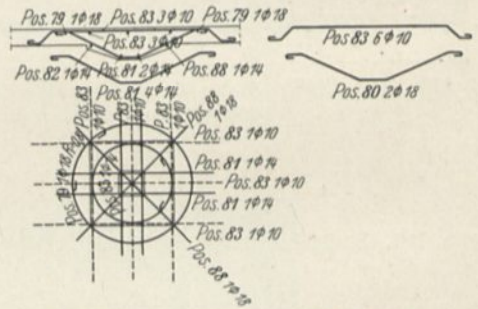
Bewehrungseinheit des Pilzkopfes (zu Abb. 102).
